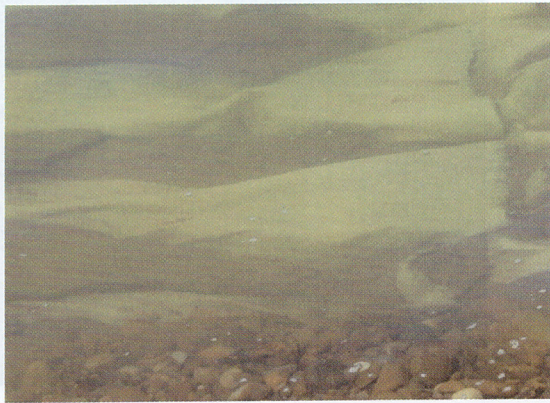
Estrutura de colchacreto em complementação ao bolsacreto
